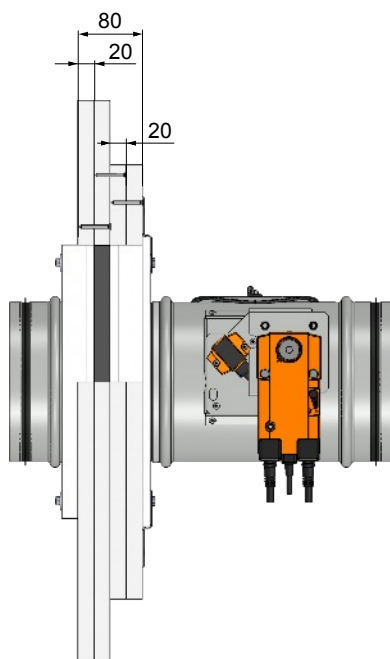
Šachtová konstrukce - instalační rám R1 - KRUHOVÁ KLAPKA
